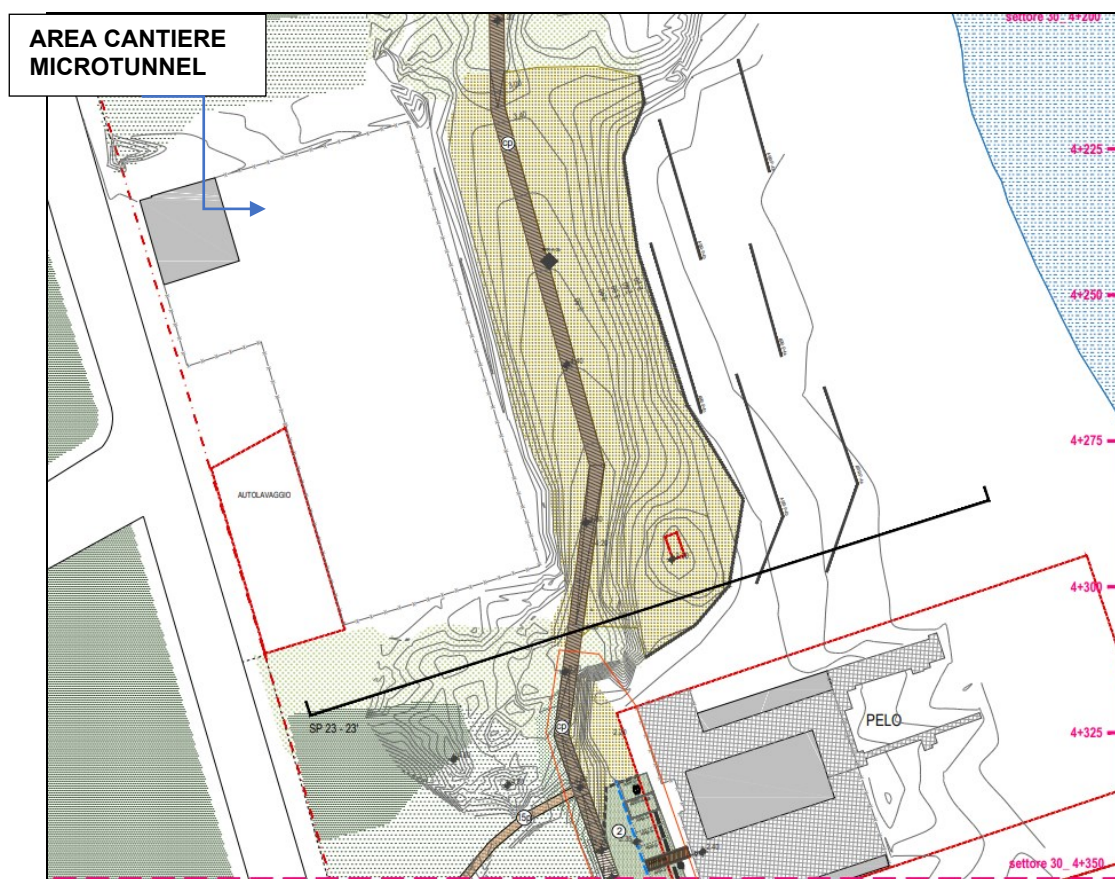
F: Stralcio planimetrico estratto dagli elaborati progettuali del Parco Marittimo di Ravenna
